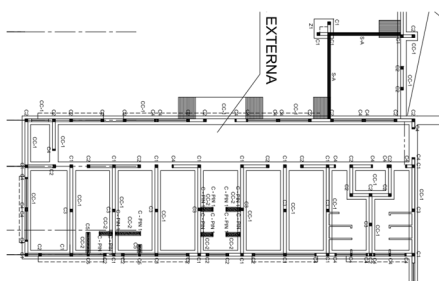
Planta de cimientos y columnas; CAIMI Santiago Atitlán
